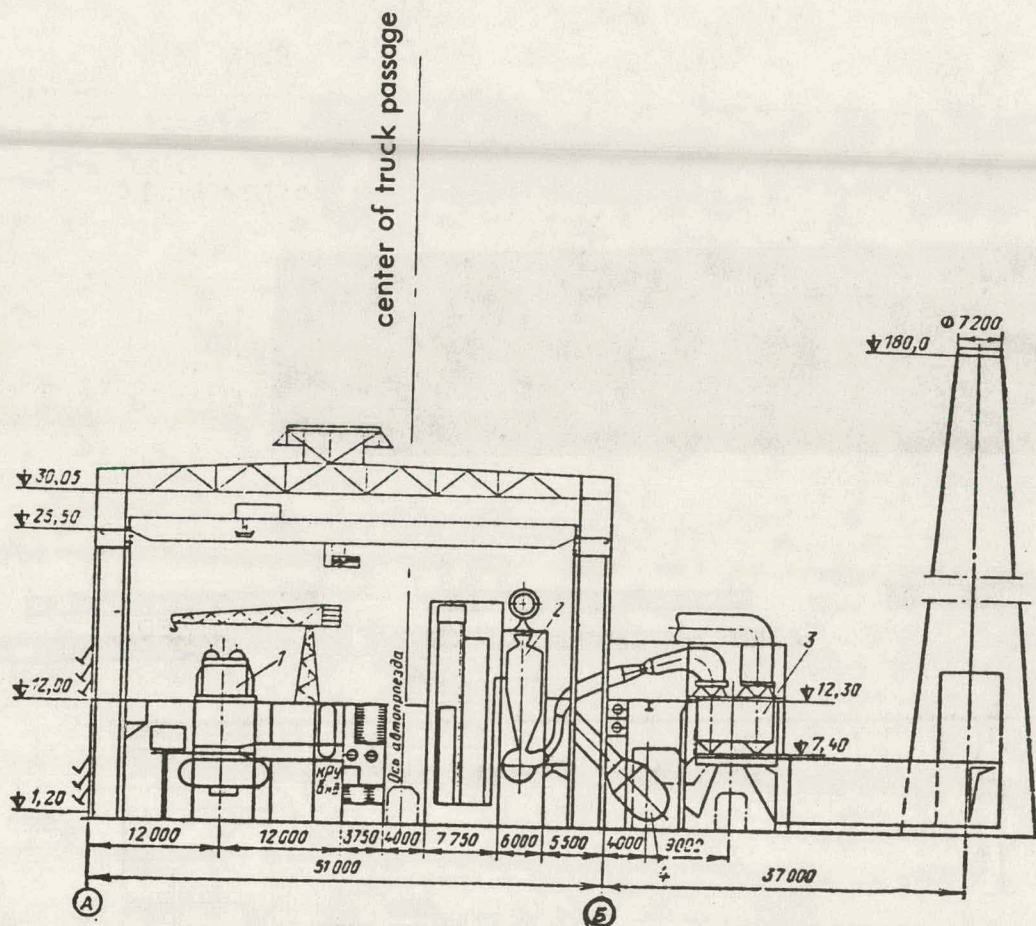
Главный корпус Ростовской ТЭЦ-2 (поперечный разрез).
